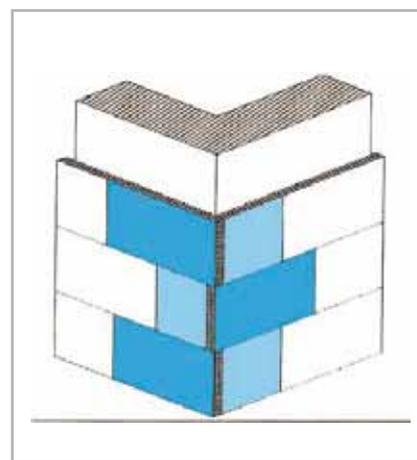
Contrapeado de los paneles aislantes en la esquina
